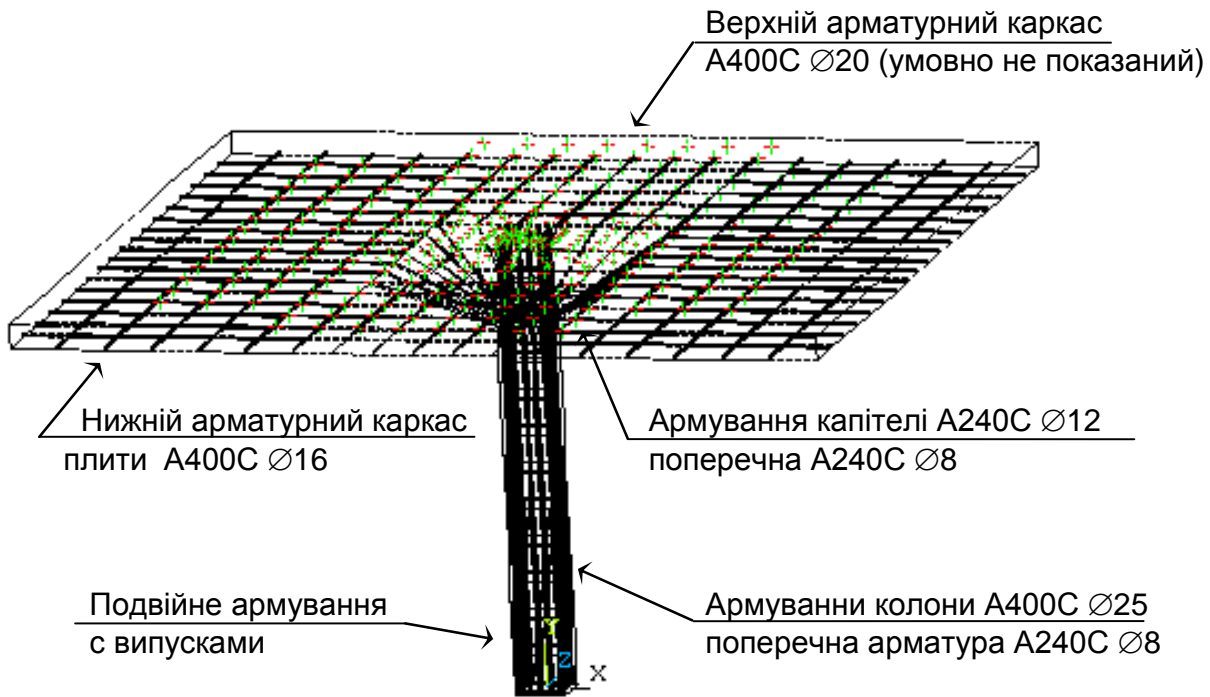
Конструктивна схема фрагменту будівлі нижнього ярусу
